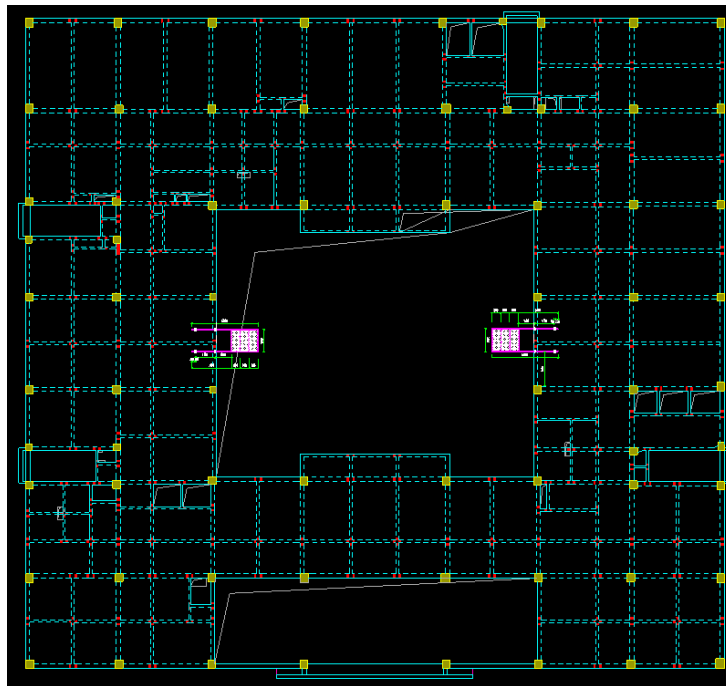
智慧水务中心悬挑式卸料平台布置平面图
